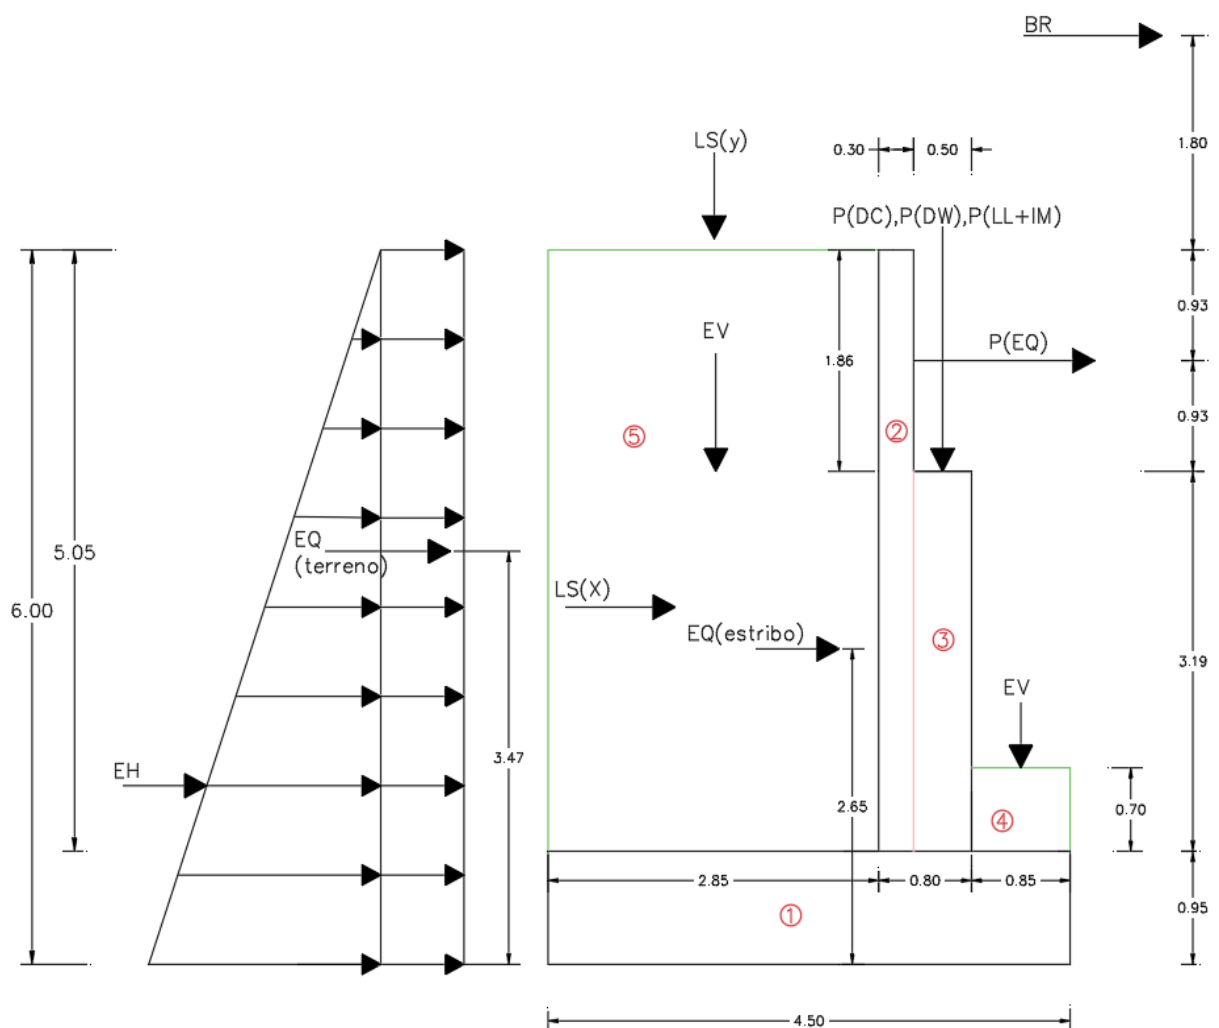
Fuerzas aplicadas en el estribo. Fuente: (Autor)
